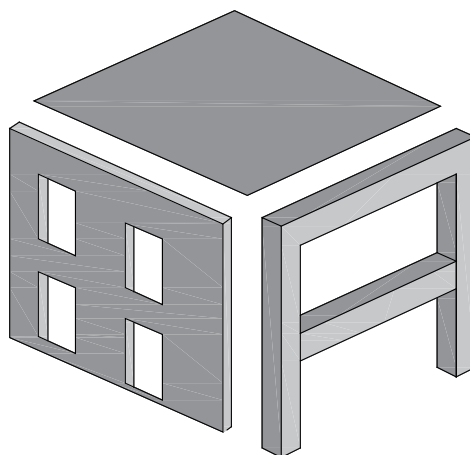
Elementet horizontale dhe vertikale të strukturës
